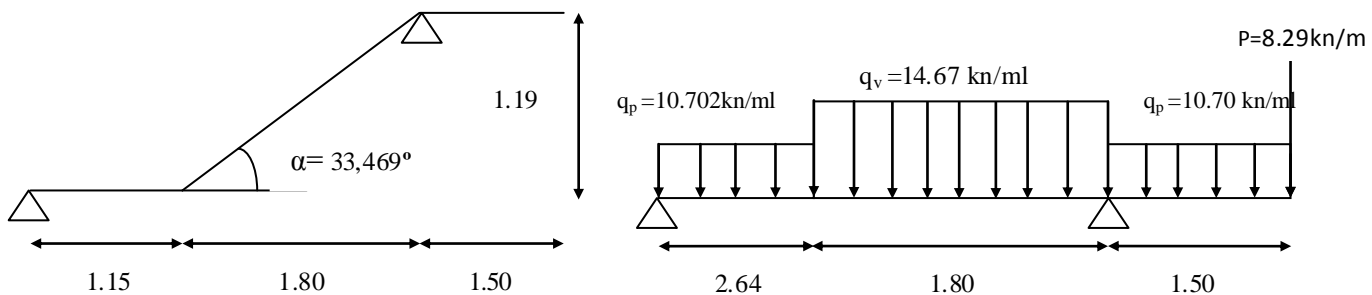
Schéma statique du 5^{ème} type d'escalier
